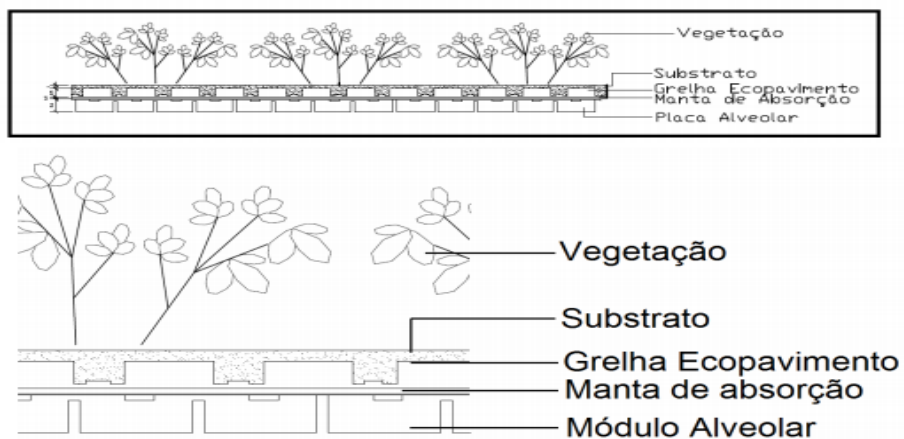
Esquema de sistema alveolar grelhado do telhado verde
